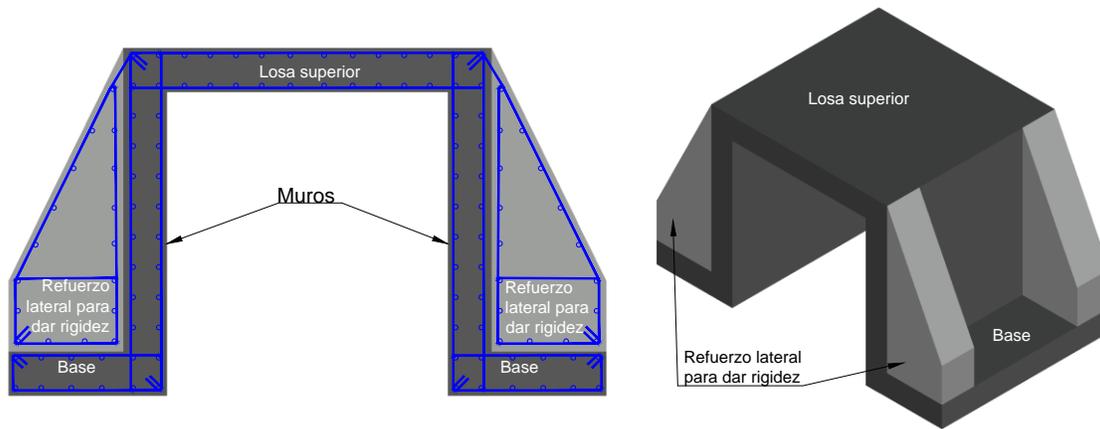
Cajón prefabricado como obra mixta (drenaje y PSFA)
